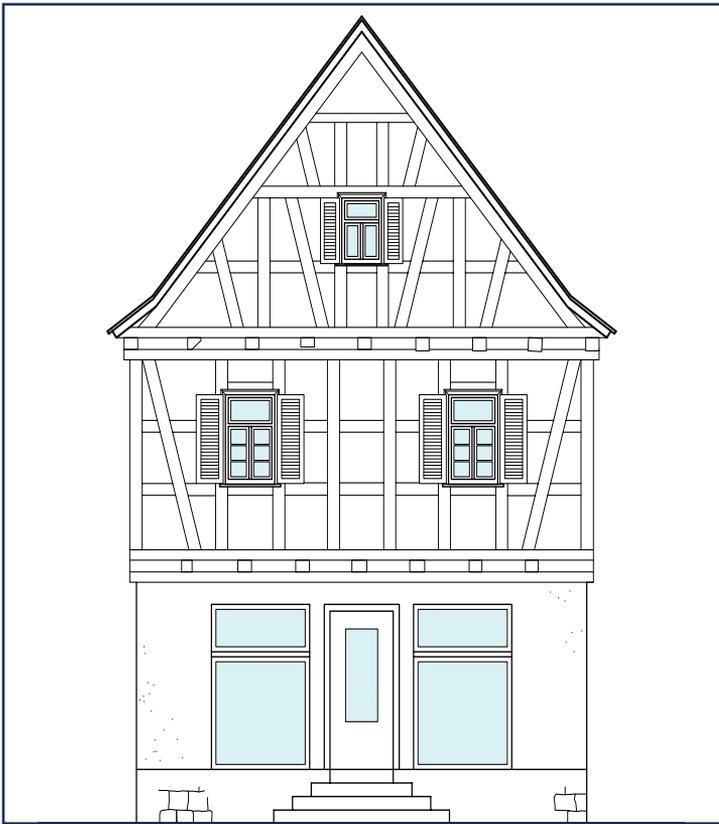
Schemaskizze möglicher Anordnungen von Schaufenstern bei Fachwerkgebäuden
